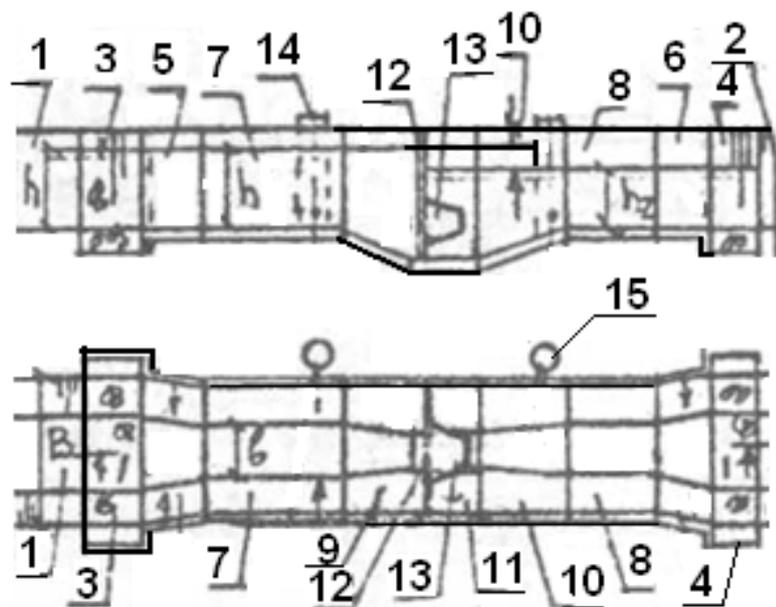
Водомерный сходящийся насадок САНИИРИ в отдельной стенке
